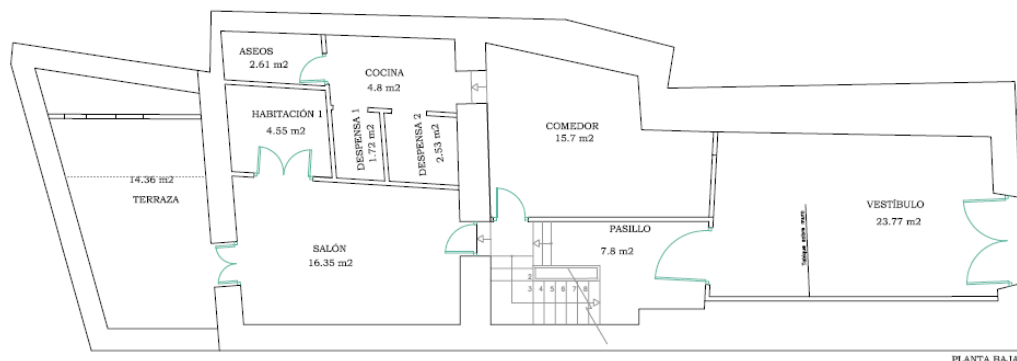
Plano distribución y superficies planta baja Anexo 9.2 P.6
